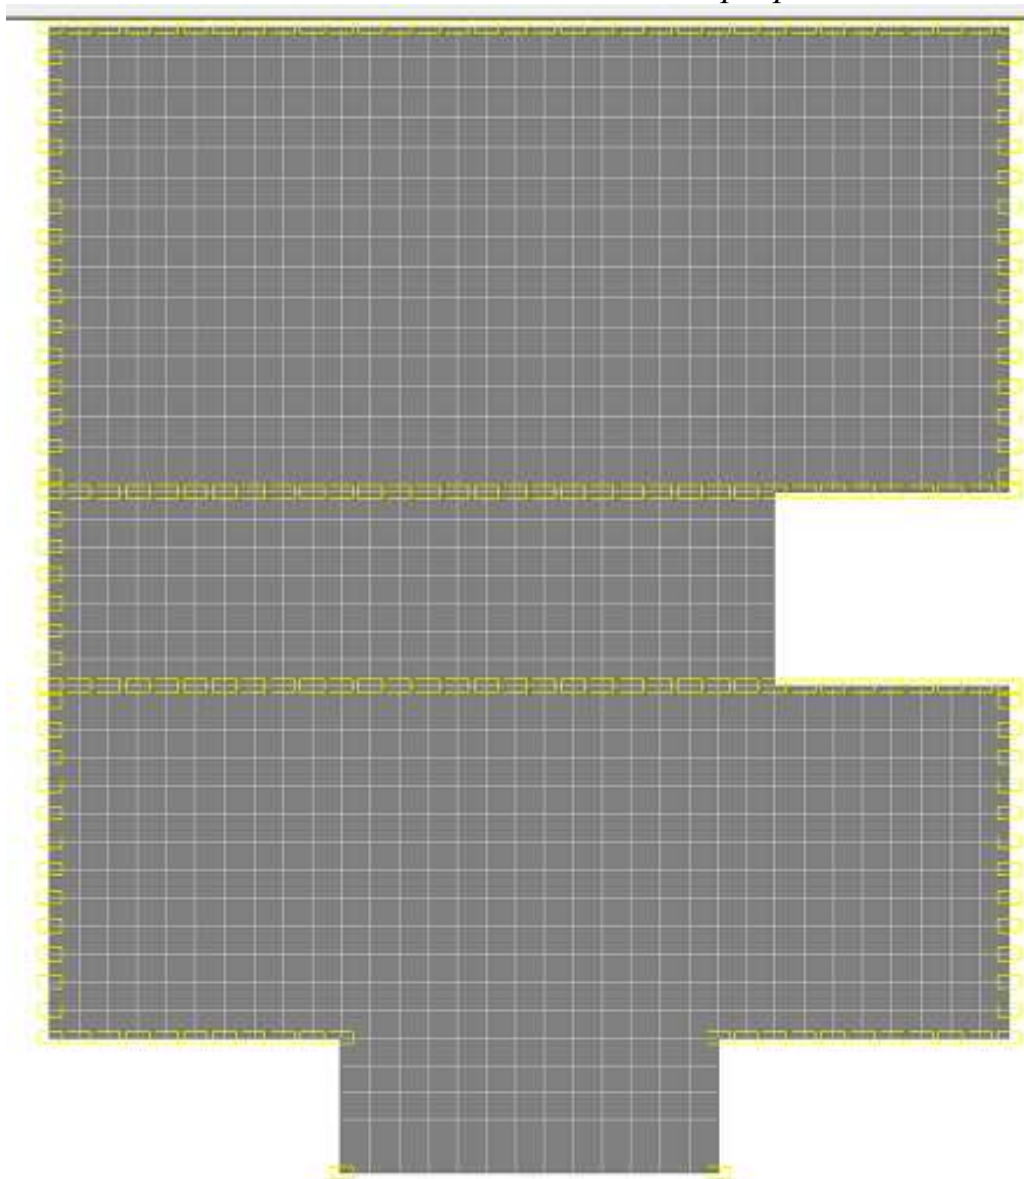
Расчетная схема монолитной плиты перекрытия.
